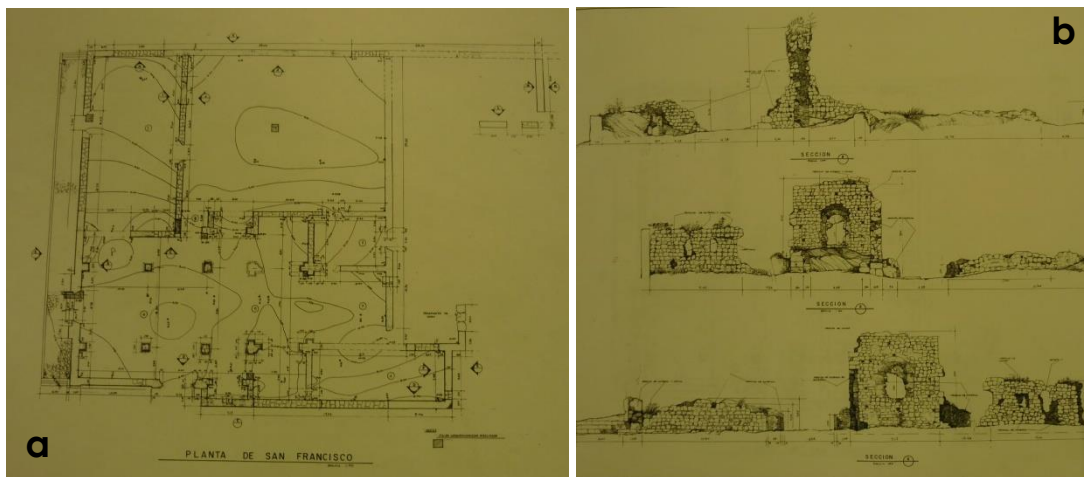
levantamientos arquitectónicos del convento de San Francisco (a, planta arquitectónica; b, fachadas y secciones), realizados por el Arq. Carlos Flores Marini, c. 1980 (PPV y BINAL).
